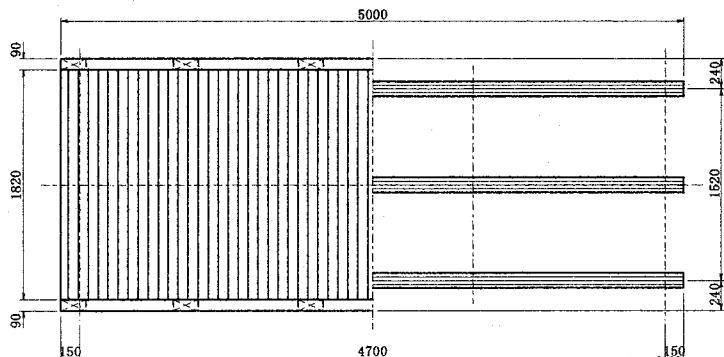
試設計例 一般図 (30年タイプ 橋長5m)
